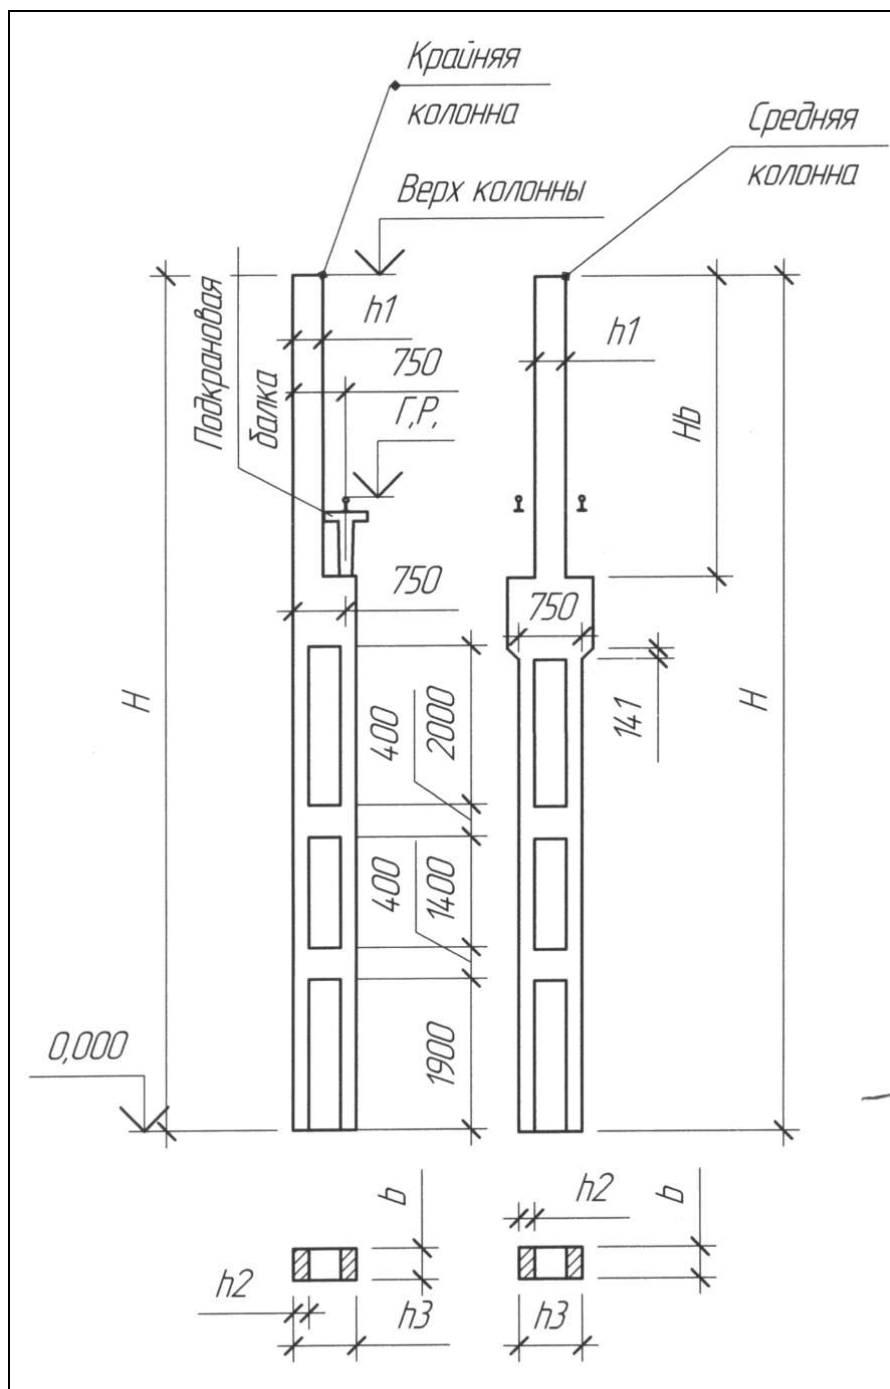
Конструкция двухветвенных колонн для зданий с мостовыми кранами
